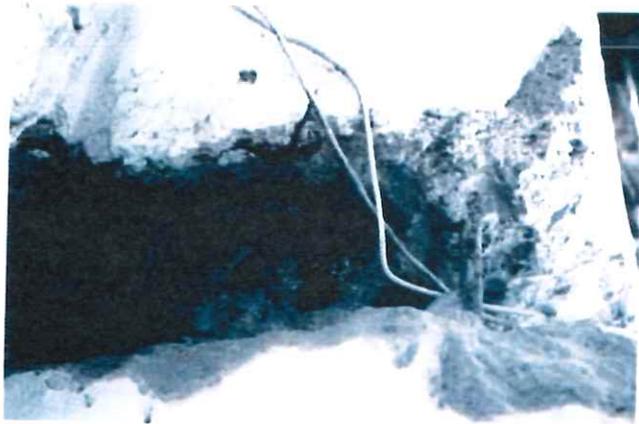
Detalle de armado de Columnas con acero liso y material muy degradable
